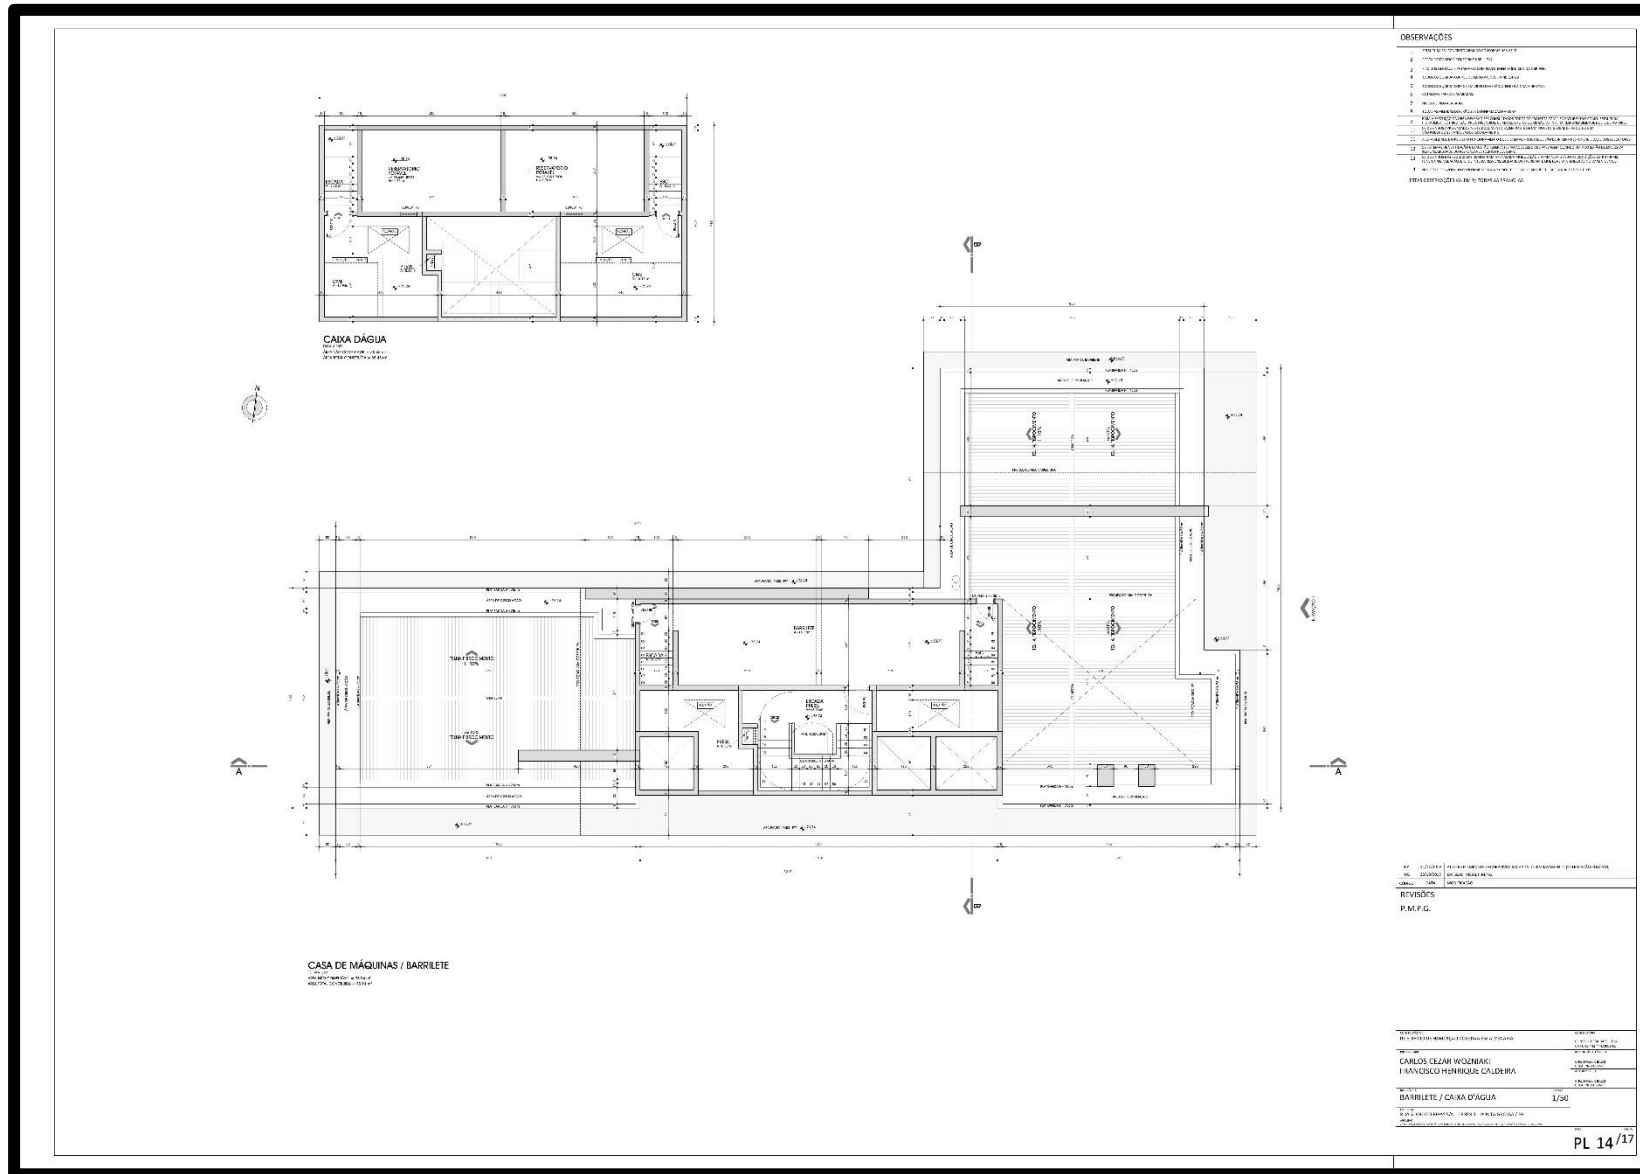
Casa de máquinas e barrilete. Fonte: Construtora Bazzi (2020).
